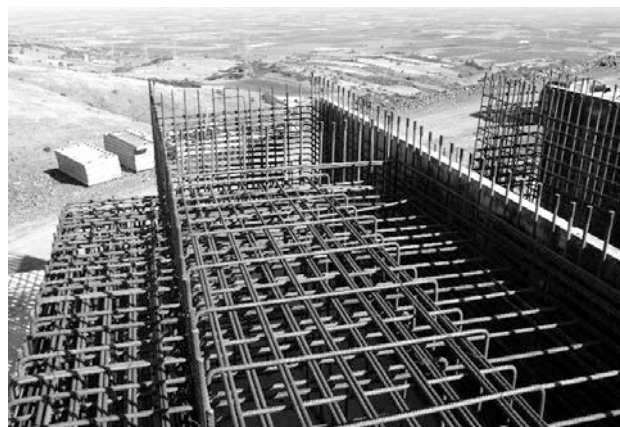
Ferralla del estribo A2 de la estructura SG25, con manguitos para conexión entre fases
